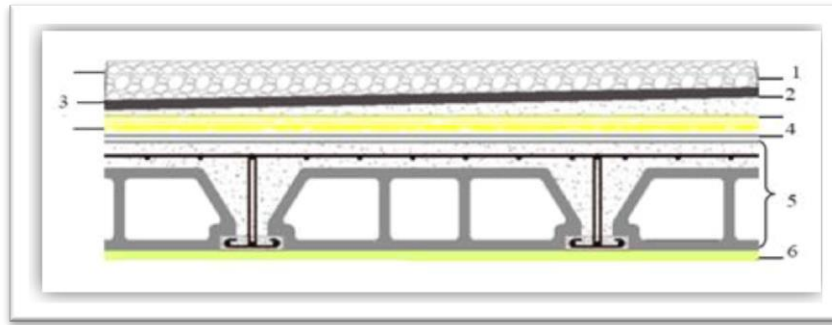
a: Composants d'un plancher terrasse en corps creux .
